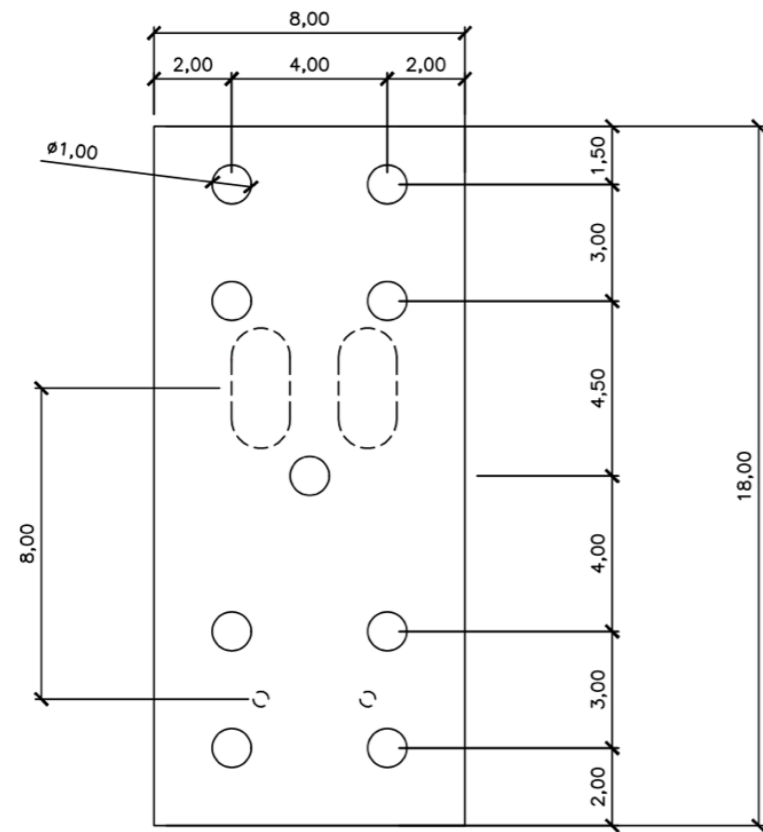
Dimensiones en metros del encepado y configuración en planta adoptada para los pilotes. Fuente: Elaboración propia.
